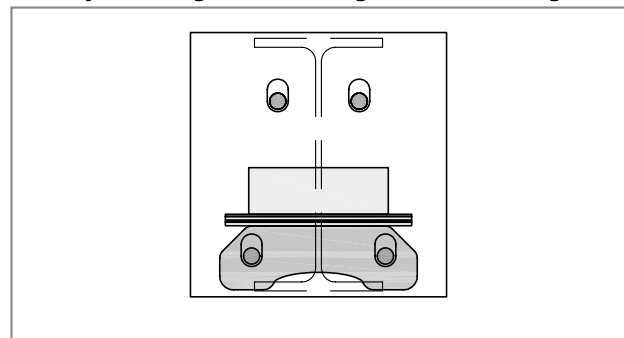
Schöck Isokorb®: Anschluss Stahl – Stahlbeton; Distanzplättchen auf der Lastaufnahmeplatte erhöhen die Lage des Stahlträgers um bis zu 20 mm
